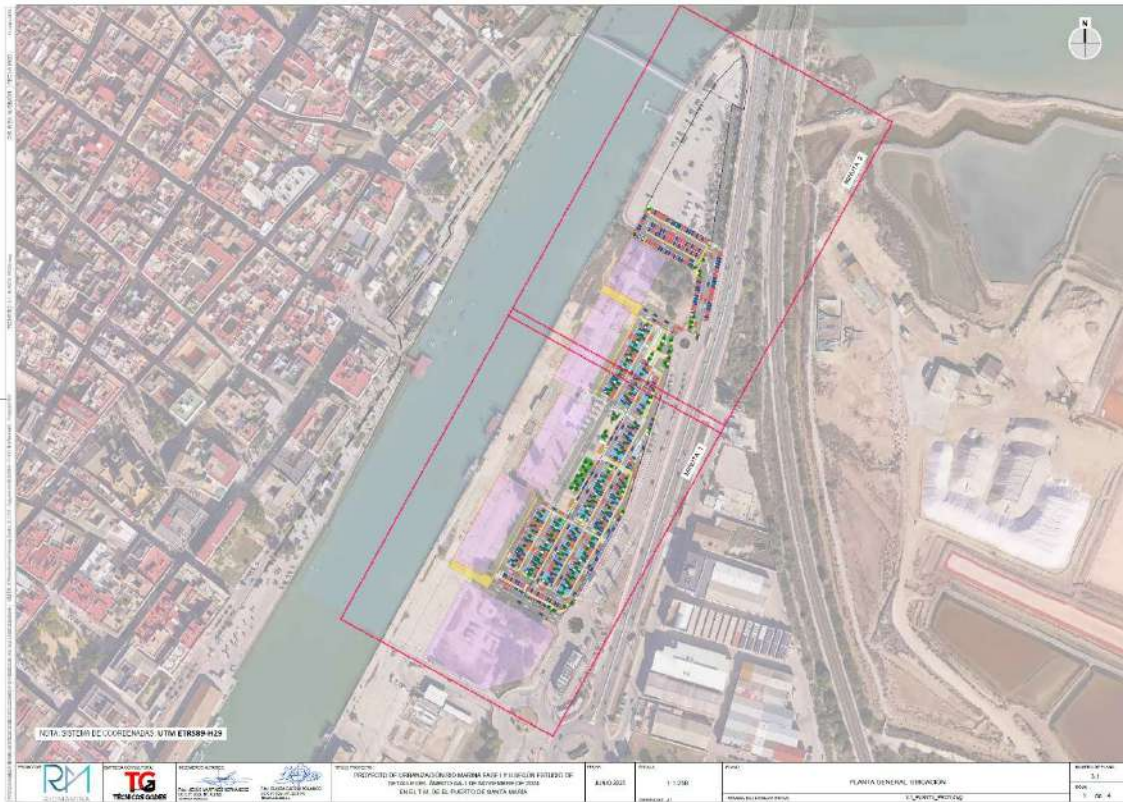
Planta General. Ubicación. Fuente: Proyecto de Urbanización.
